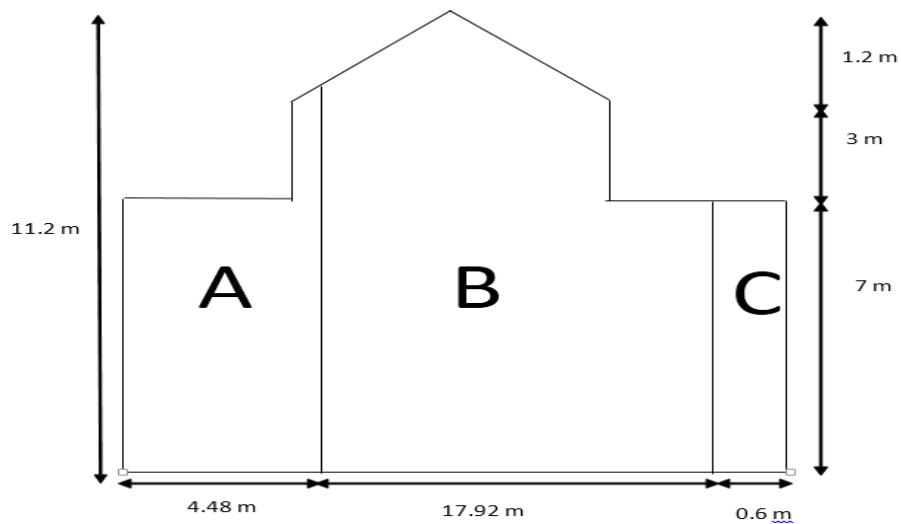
Zone de pression sur les parois verticales « pignon »
